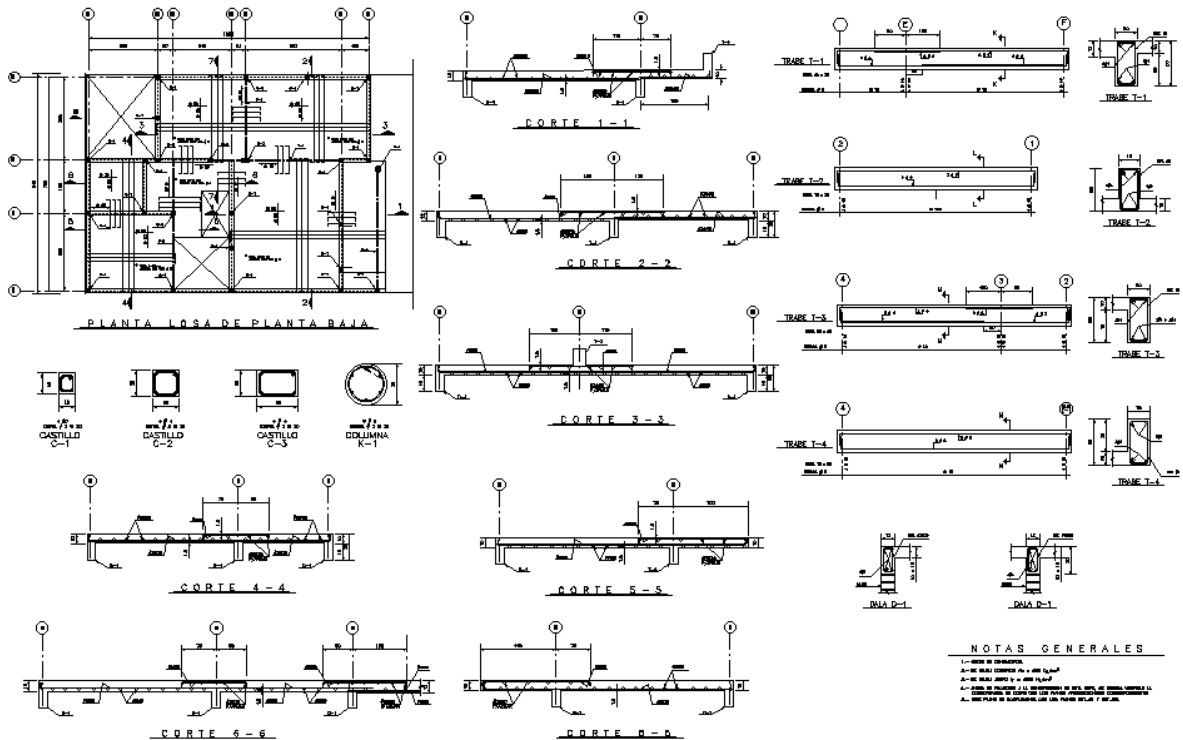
Plano de proyecto estructural de losa de entresuelo. Autoría propia
